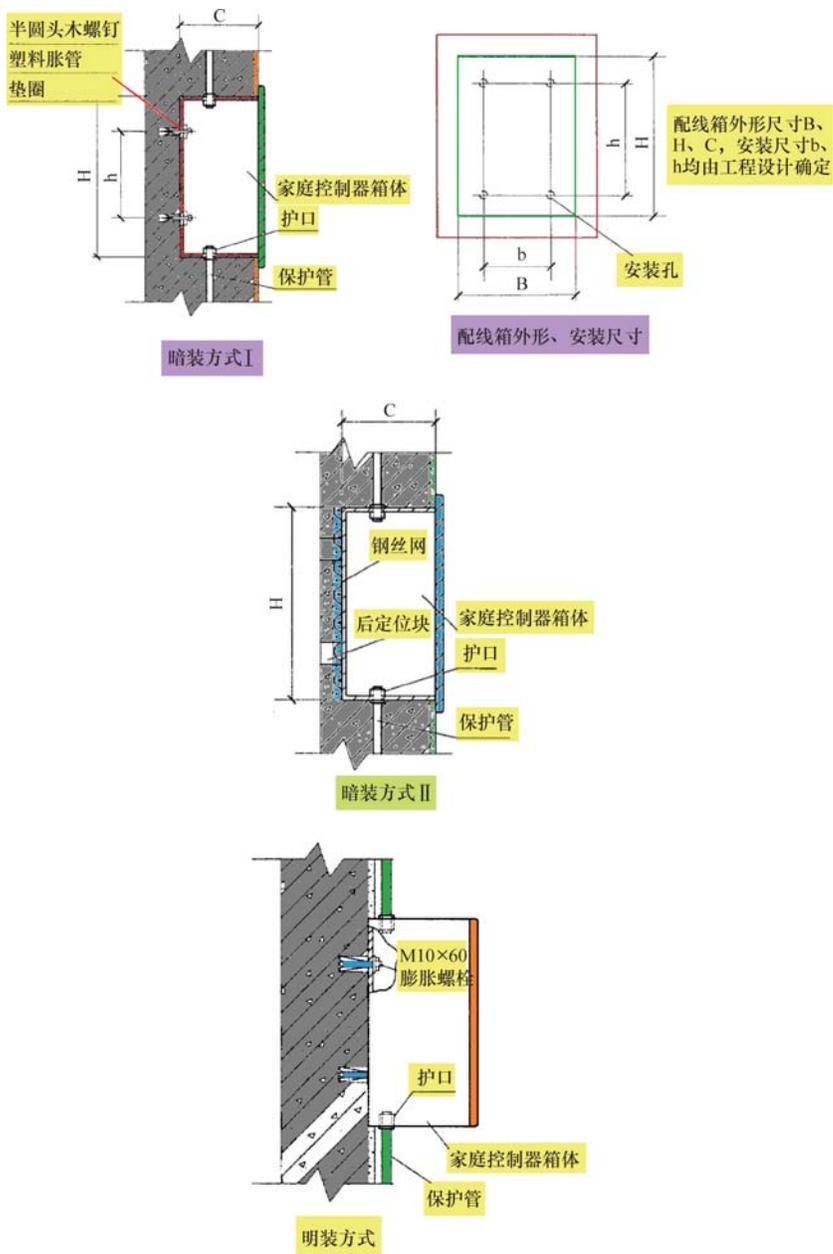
家庭控制器在钢筋混凝土墙上的安装图例
